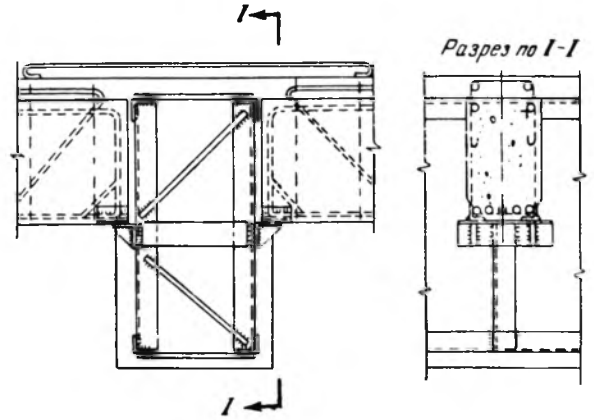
Сопряжение сборных железобетонных балок с каркасом ригеля.
